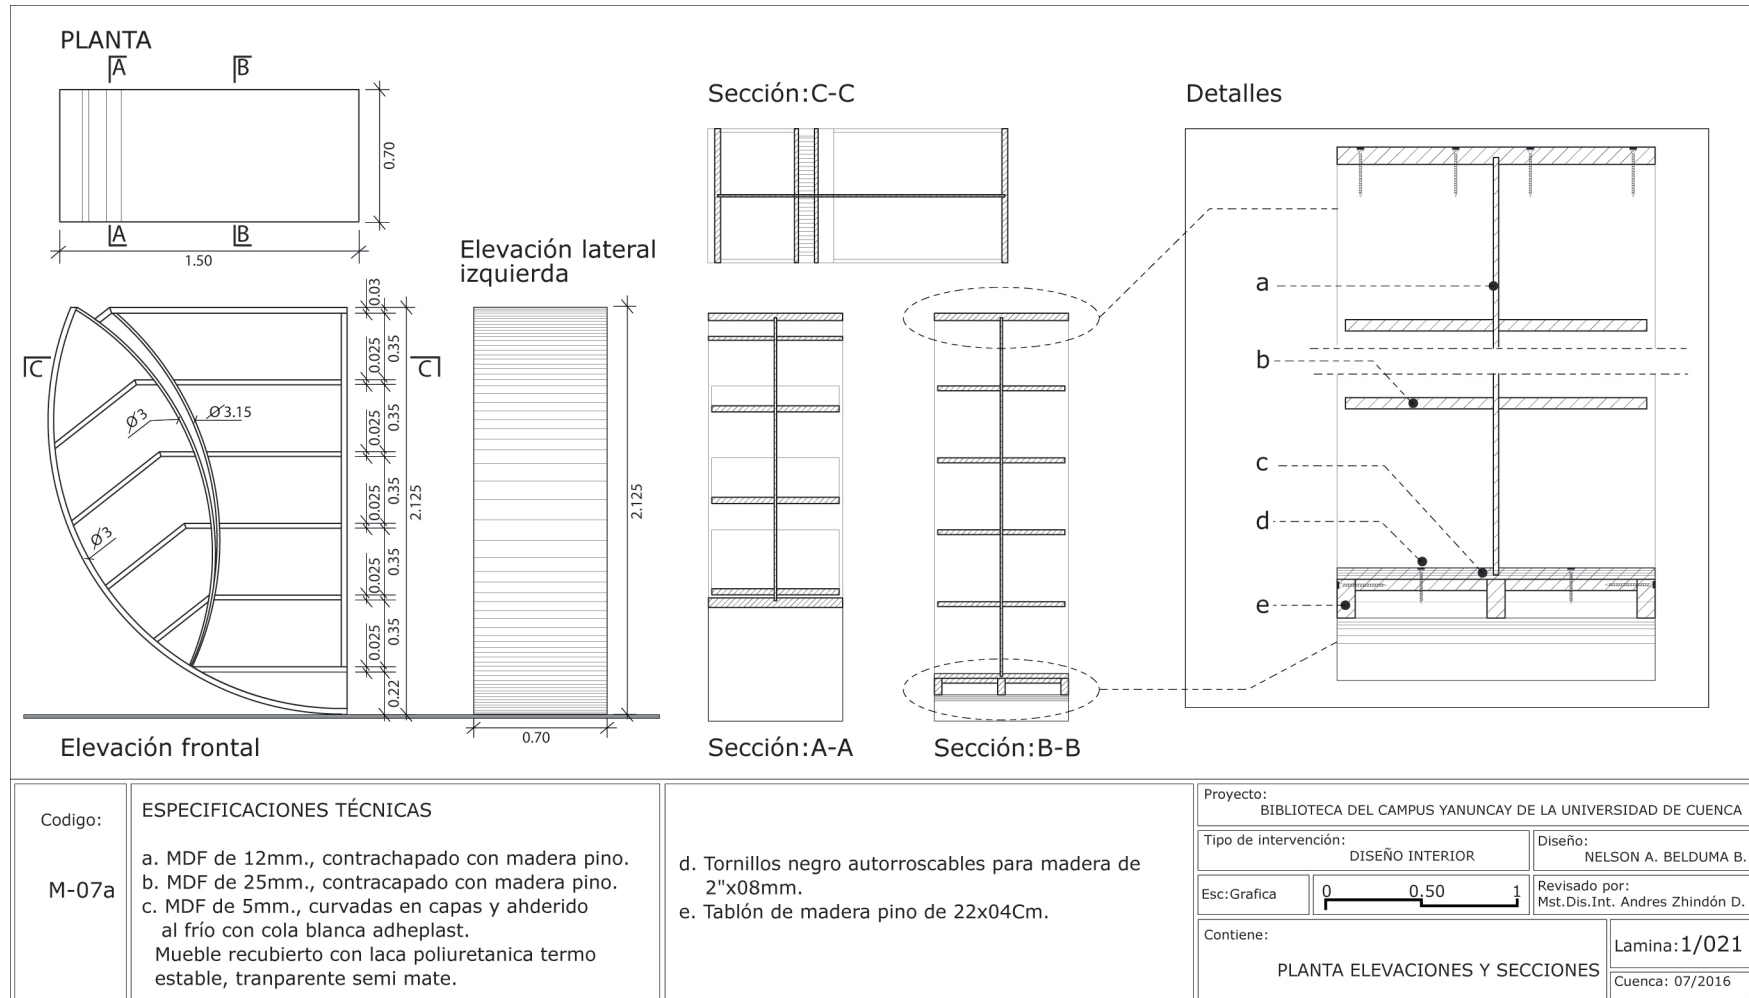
Planta, elevaciones y secciones. Estanterías. M-07a.
